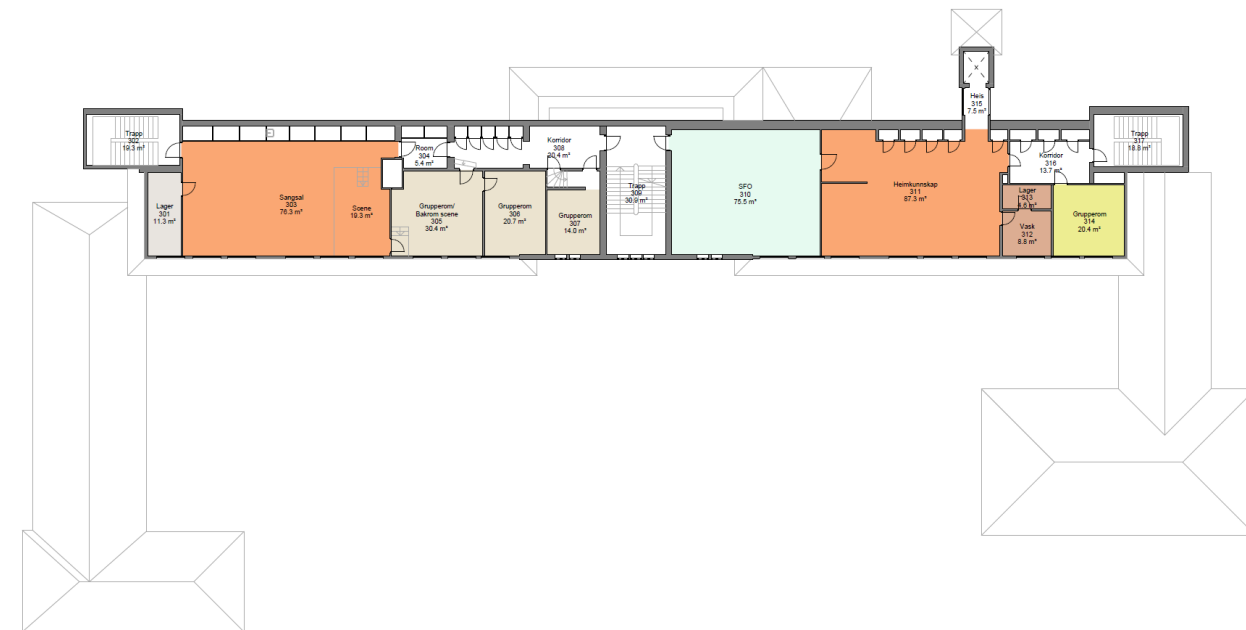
Plantegning under-etasje. Eksisterende situasjon Fløgstad skule.
